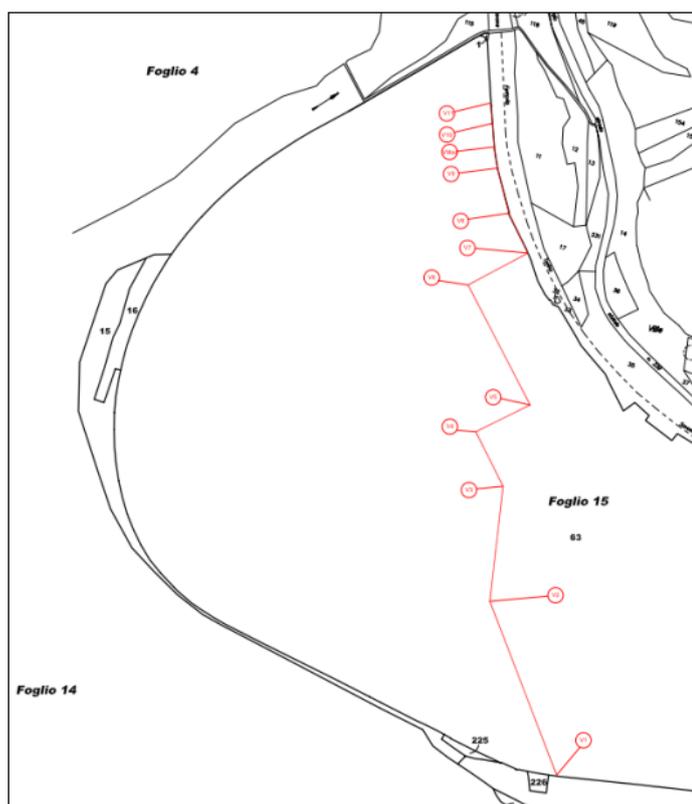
Estratto da planimetria catastale con individuazione dello sviluppo del setto di separazione A1/A2 (tratto da Progetto Esecutivo del setto di separazione Zone A1 e A2 –Tav. 03-01-BL-A-94439 – Snamprogetti. [5] Allegato 5m)
